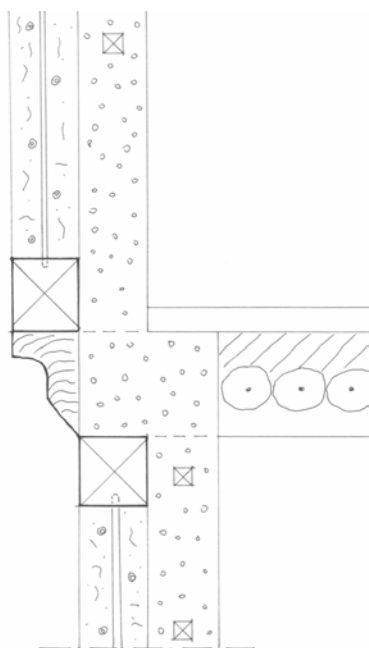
Anschluss der Geschosdecke (Detailplanung)
